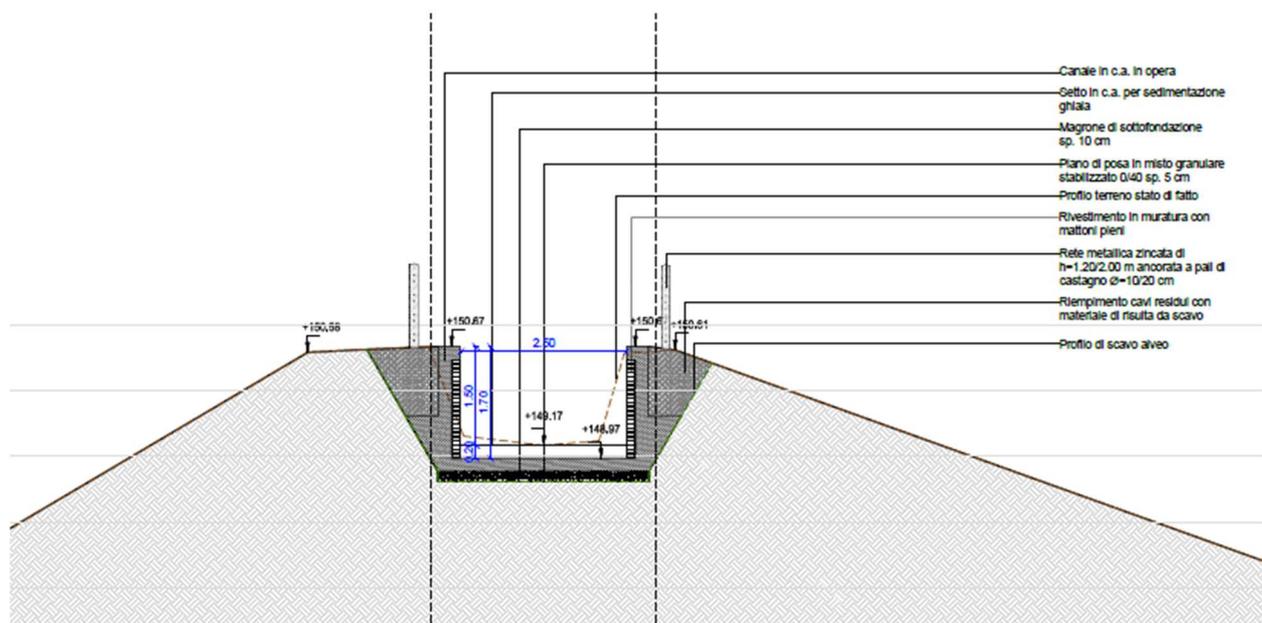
Intervento di risezionamento alveo: sezione tipo
